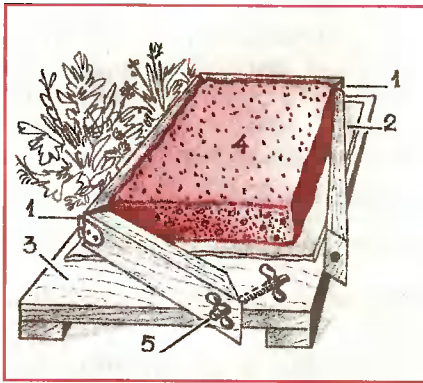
Разъемная опалубка для заливки плит дорожки: 1—петля, 2—картон, 3—основание, 4—отливка, 5—барашковая гайка.
